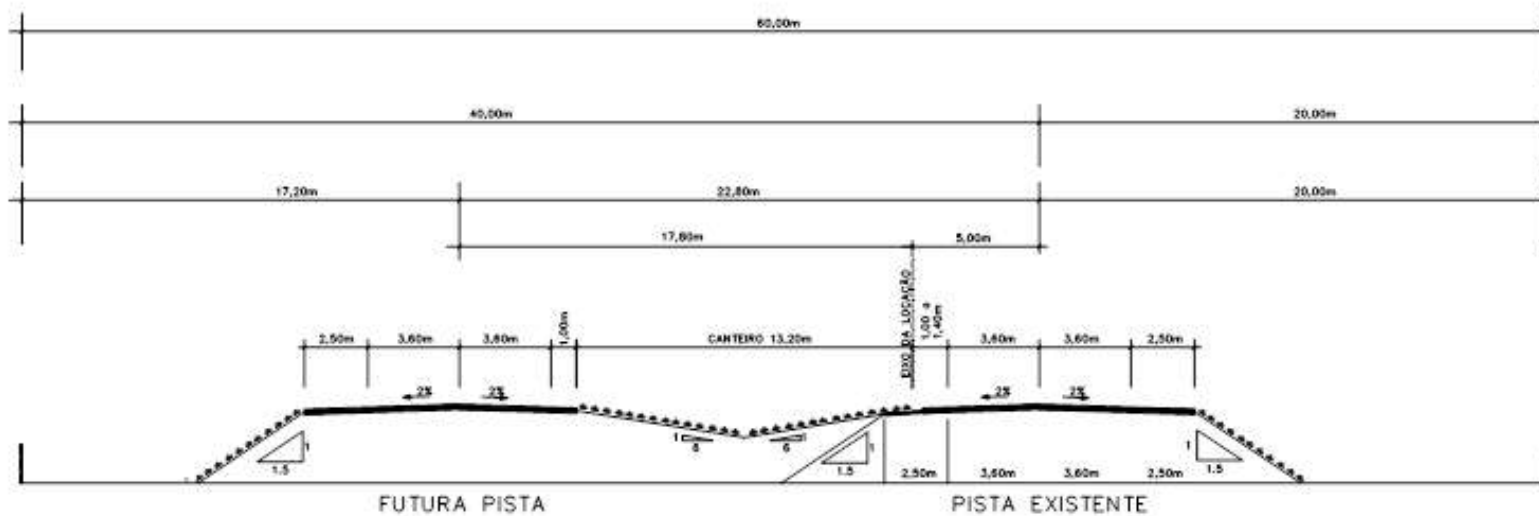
Seção transversal-tipo em zona rural – Lote 4
